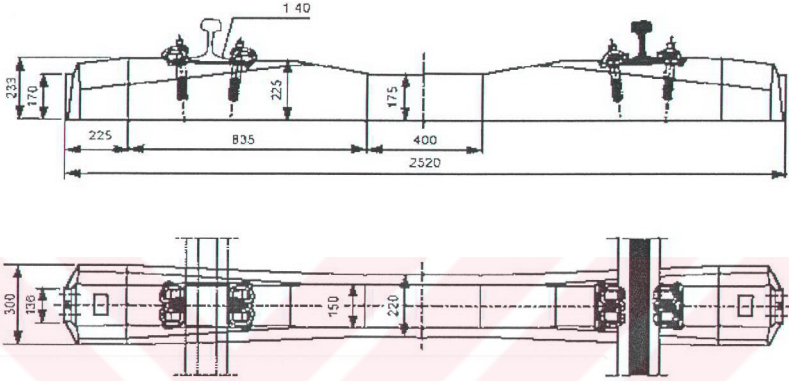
Betonarme travers uygulaması (Erkul, 2002).
